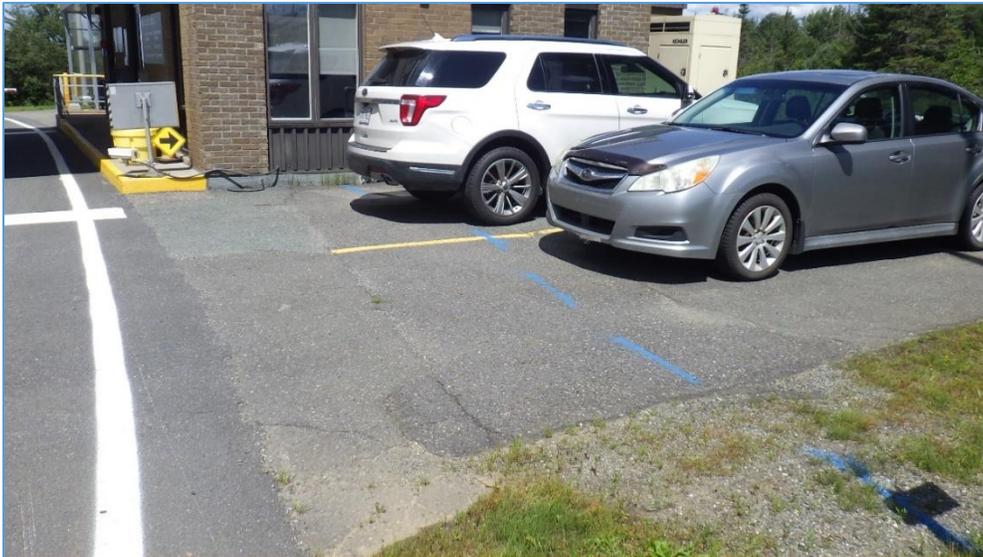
Revêtement et enrobé bitumineux à enlever et replacer après la mise en place de la conduite au poste de Chartierville.
